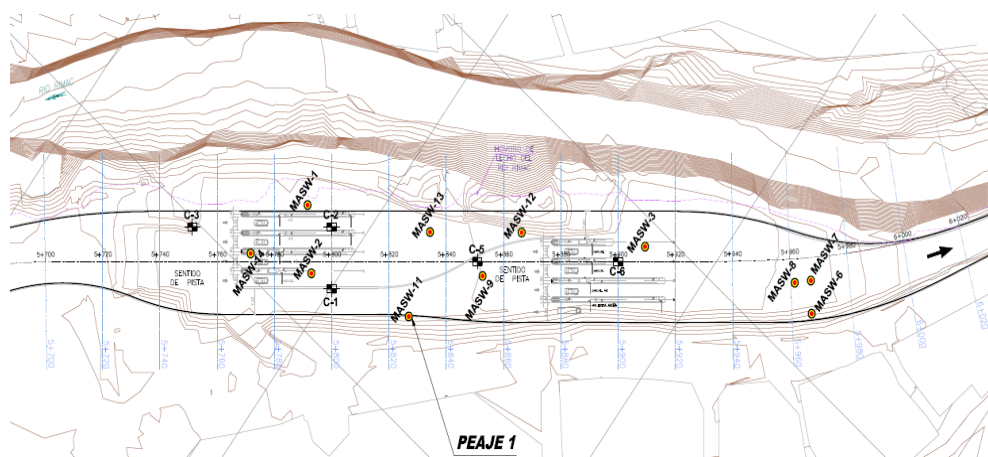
Perfil Estratigráfico - Planta Perfil Longitudinal
